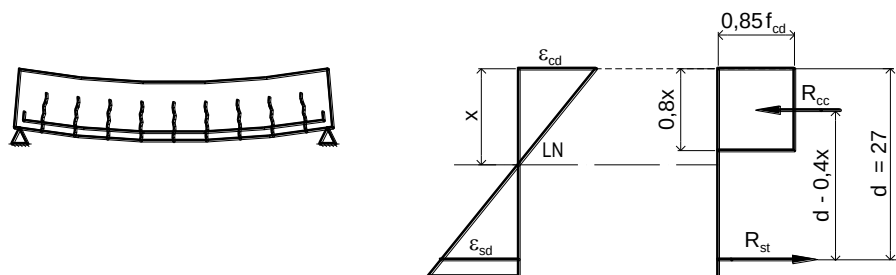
Laje em Concreto Armado no Estado-Limite Último (ELU).
